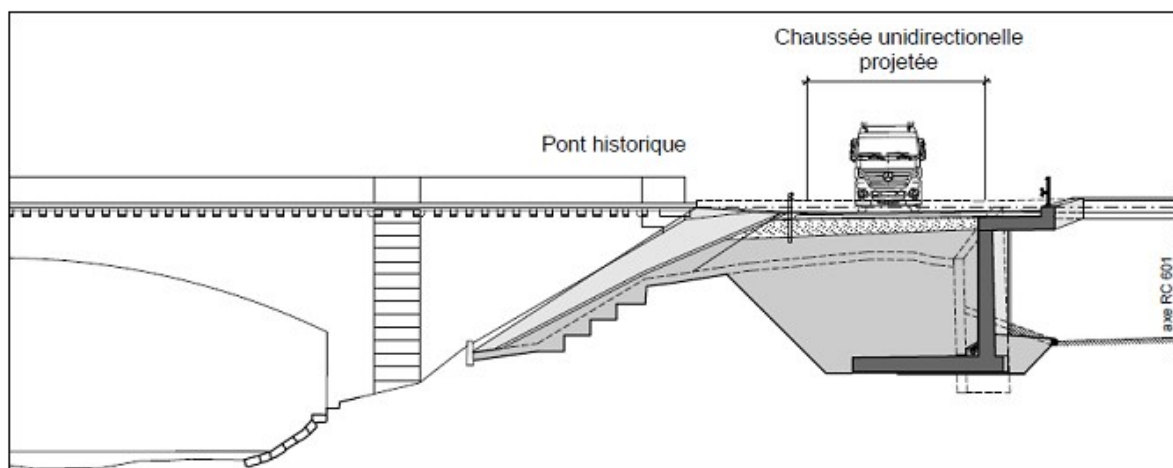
Nouvelle bretelle, profil en travers n° 1
